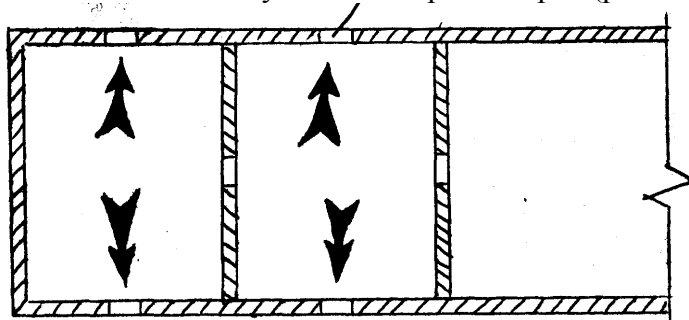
Устройство дымовых люков в наружных стенах зданий с несгораемыми ограждениями (холодильники):
